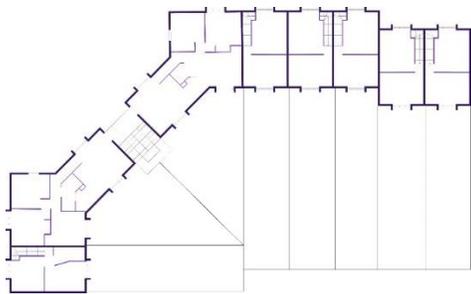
Estructura tipología 3. Fuente: Elaboración propia
